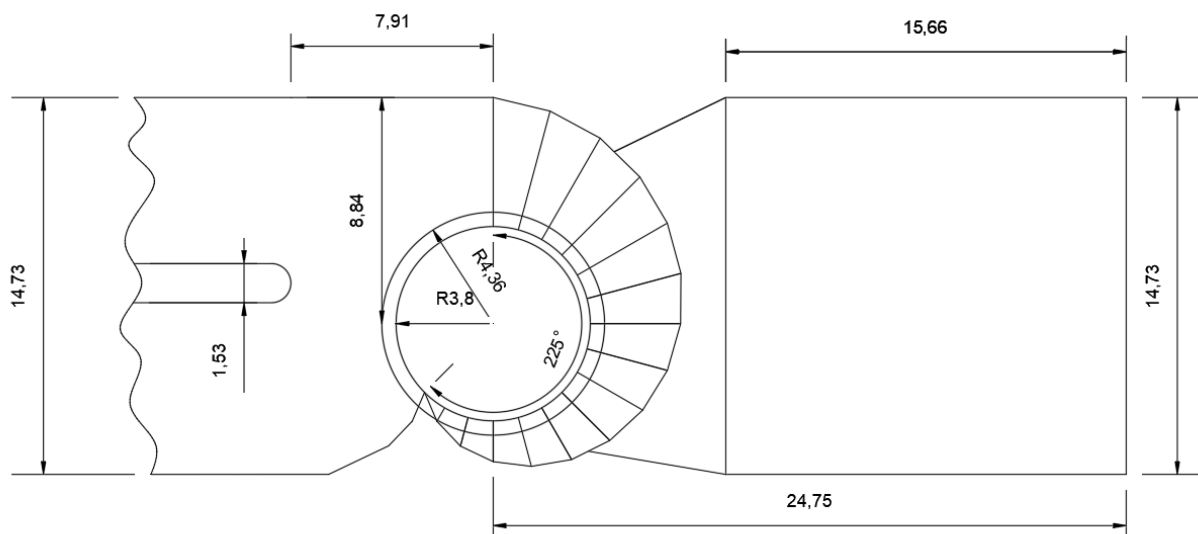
План спиральной камеры ПЛ40б-В-560
